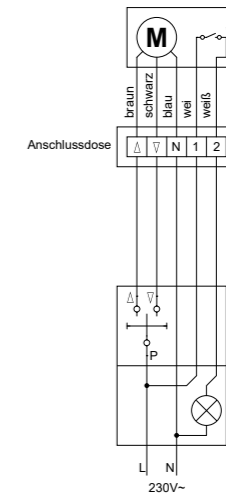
Anschlussplan des Lüftungsantriebs Typ mcr E actuator
